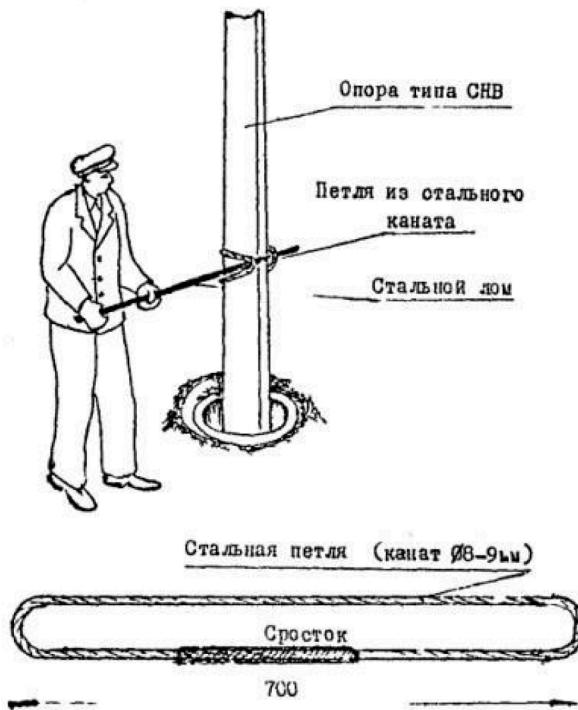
Кантование железобетонной опоры типа СНВ при помощи петли из стального каната и лома
